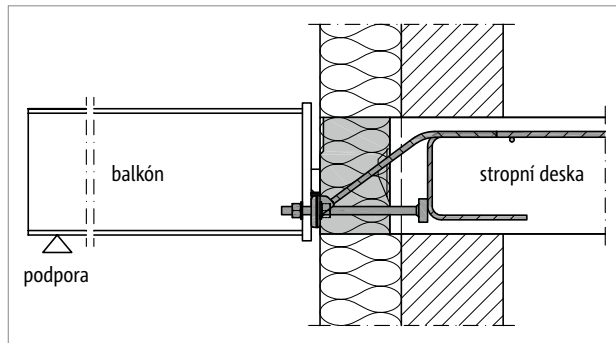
Schöck Isokorb® XT typ SQP-WU: Atypické provedení; nutné u napojení na železobetonovou stěnu
